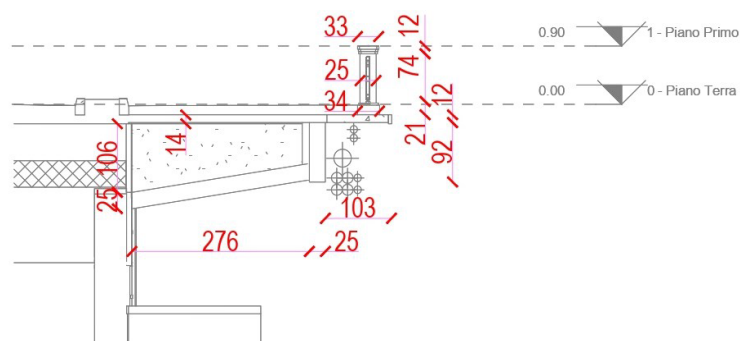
Sezione mensola nord-ovest (non oggetto del presente progetto) - Stato di fatto
